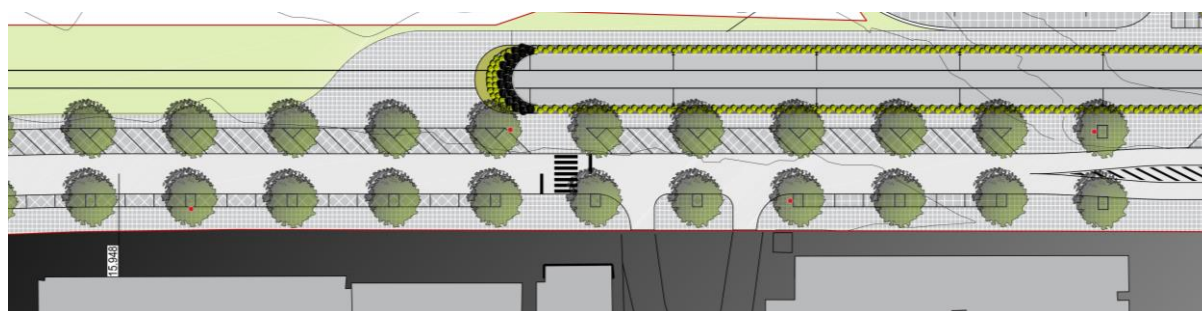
Pormenor das plantações propostas na R. Conceição Fernandes
